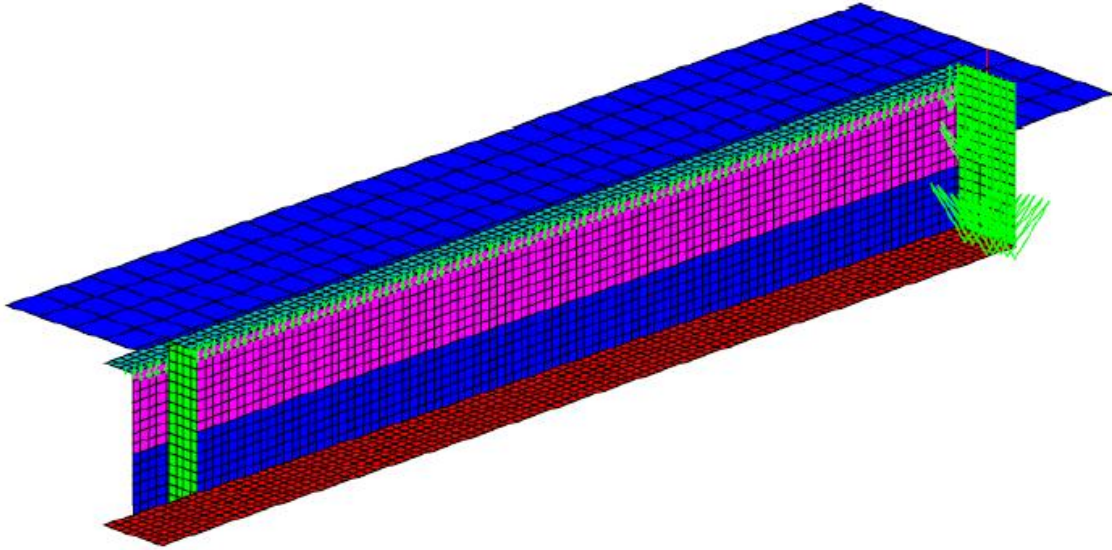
Application du chargement mécanique sur une poutre mixte
